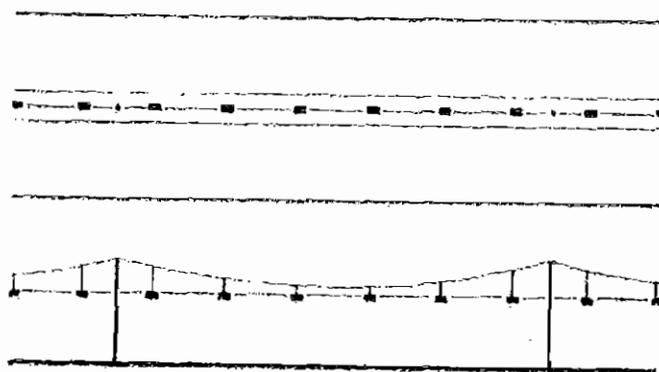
Planta y alzado de un sistema de alumbrado por catenaria.
